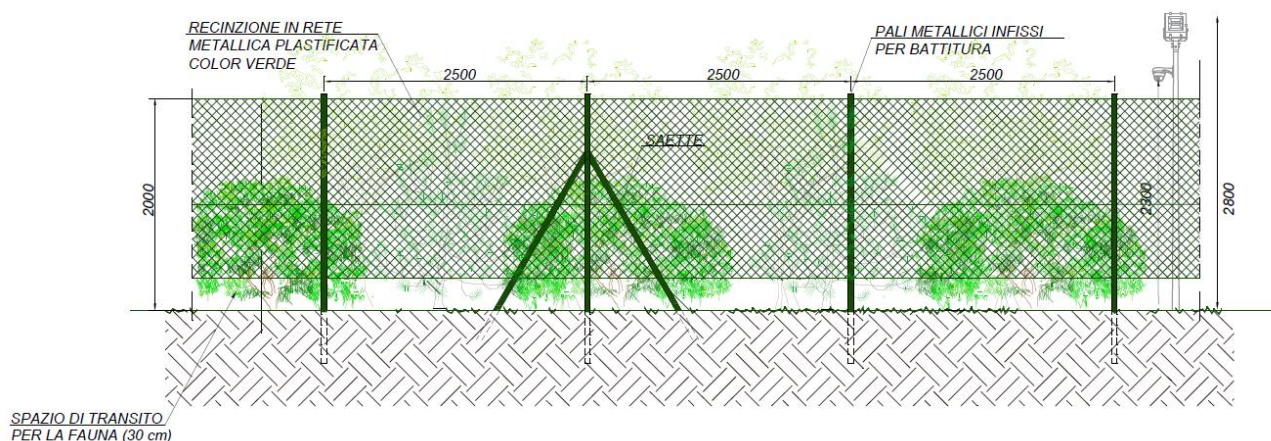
Prospetto delle opere di mitigazione e recinzione perimetrali
